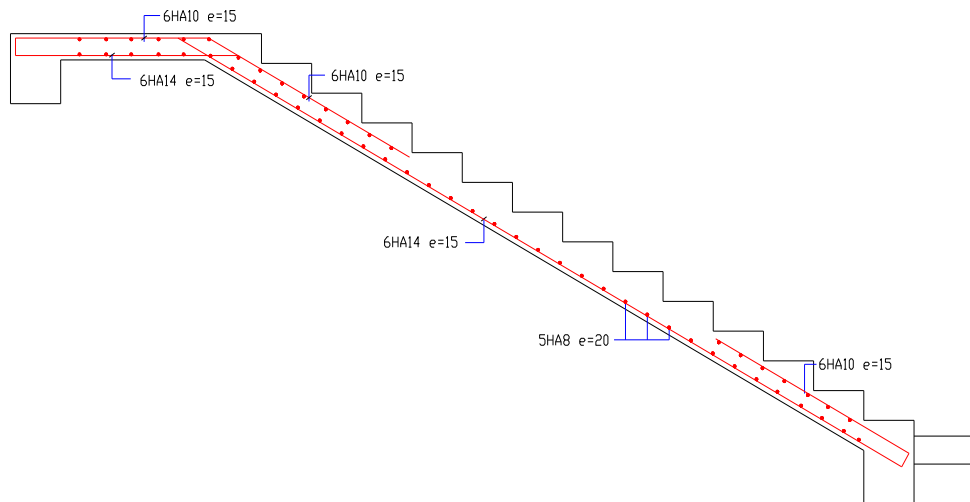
Schéma de ferrailage de l'escalier type 1 (niveau RDC).
